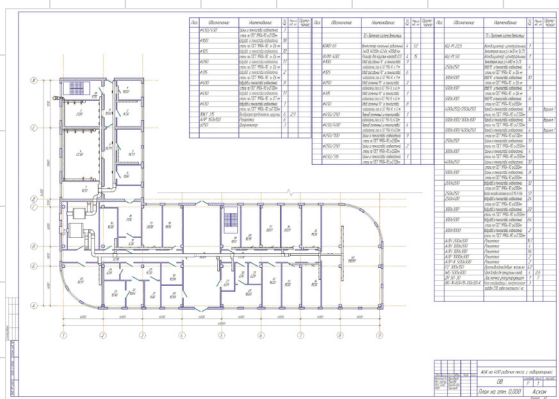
Чертеж системы вентиляции здания АБК на отметке 0,000 м
